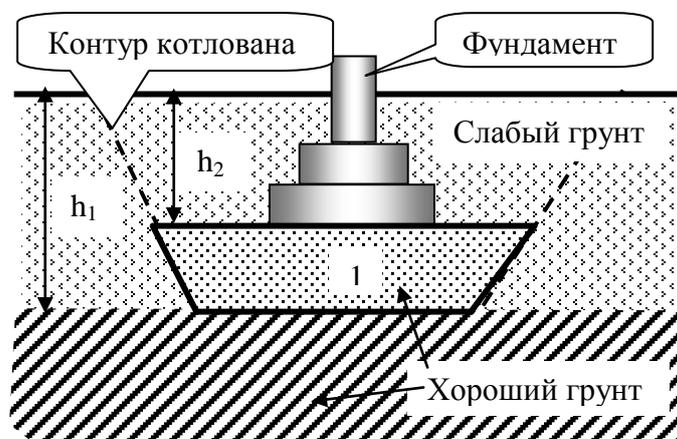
Песчаная подушка полностью прорезает слабый слой грунта
